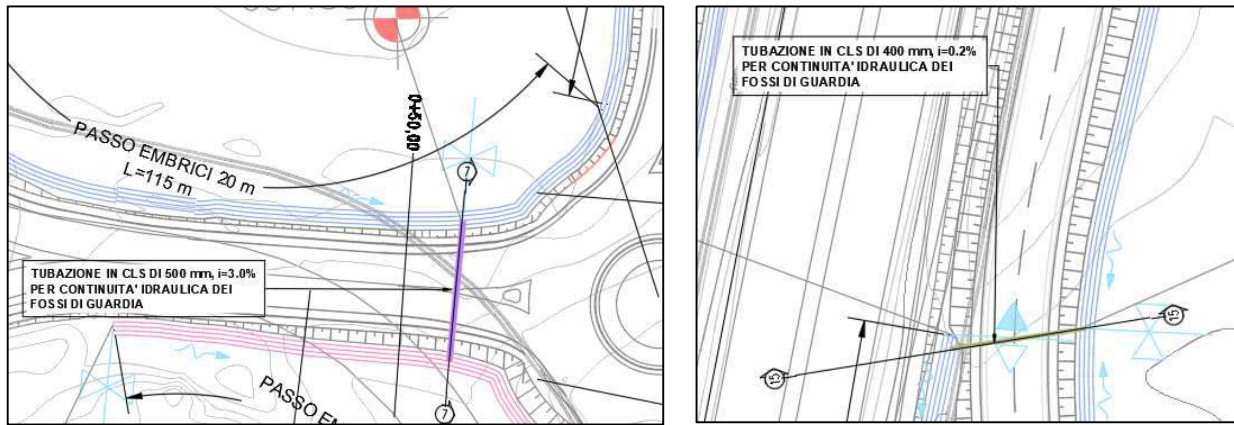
Stralcio planimetrico con ubicazione degli attraversamenti previsti in progetto
